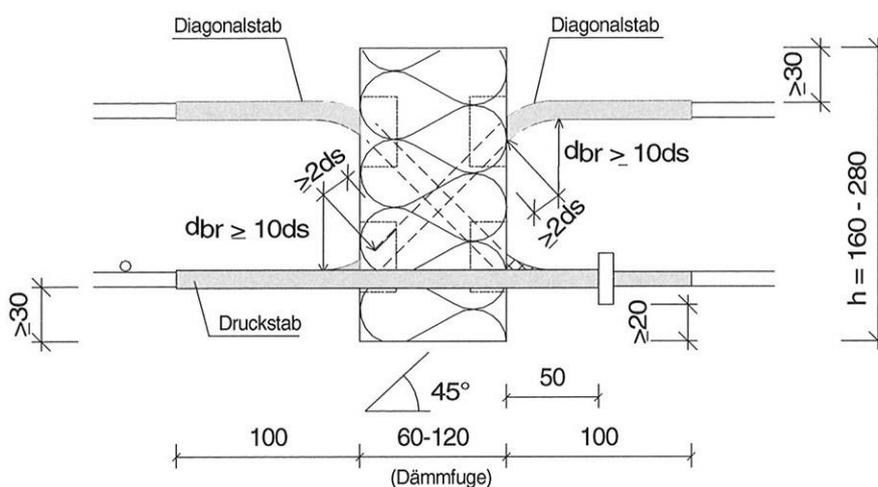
Egco box Plattenelement Typ PV-D +/-
